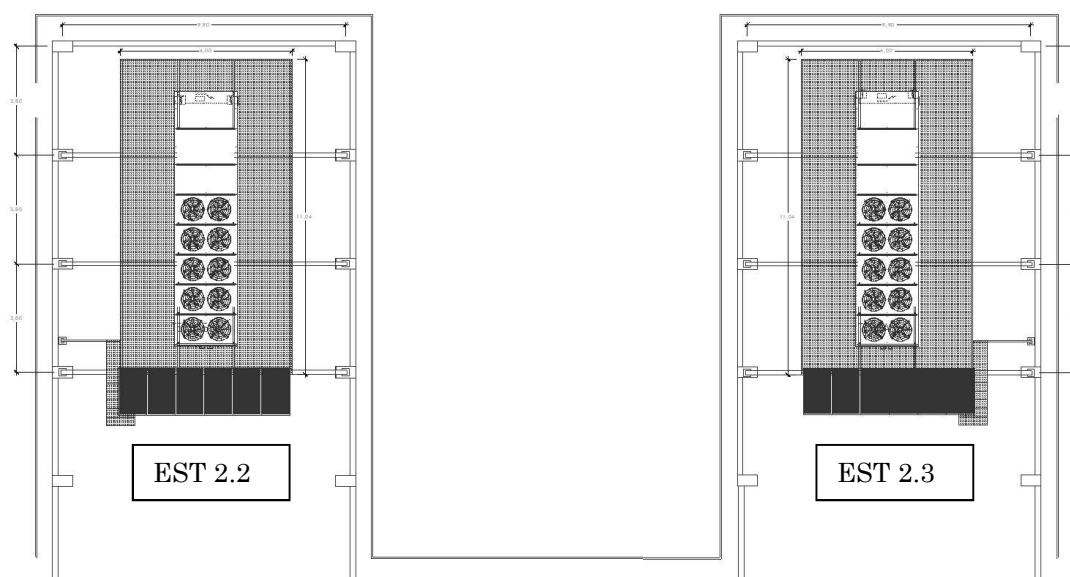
Modelo forjado de cubierta y zona de comprobación.
